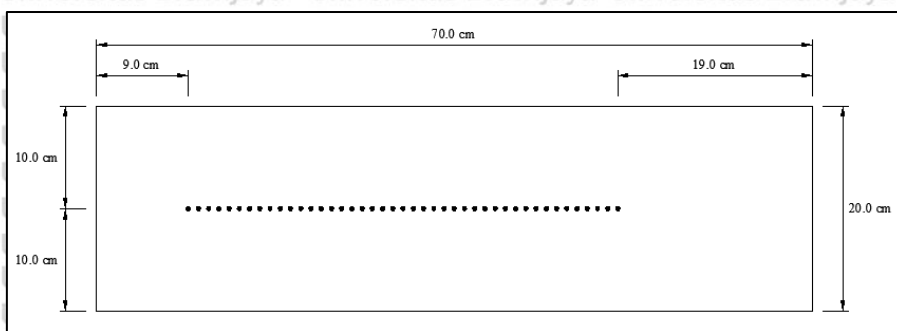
Skema pengujian B scan benda uji balok dengan lubang arah transversal
